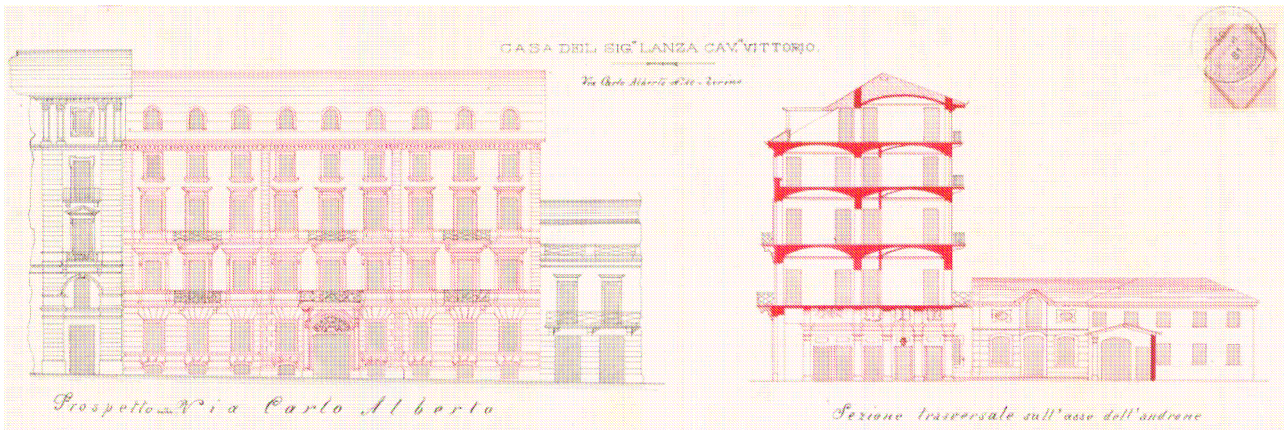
Antonio Debernardi - Prospetto e sezione di Palazzo Lanza, 1881
